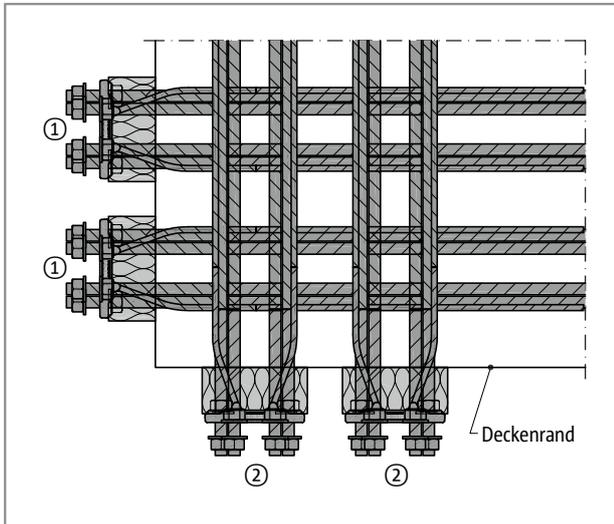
Schöck Isokorb® T Typ SK: Außenecke
